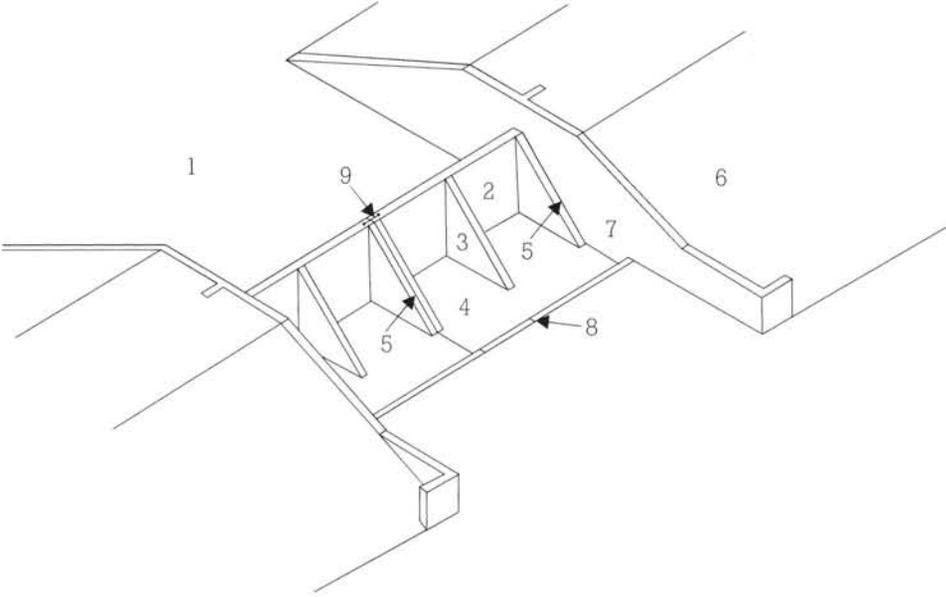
Vue en perspective d'un type de déversoir-voile en béton armé. 1 - plan d'eau ; 2 - voile en béton armé ; 3 - contrefort ; 4 - radier du bassin de dissipation ; 5 - joint de dilatation ; 6 - talus ; 7 - bajoyer ; 8 - becquet ; 9 - joint waterstop.
